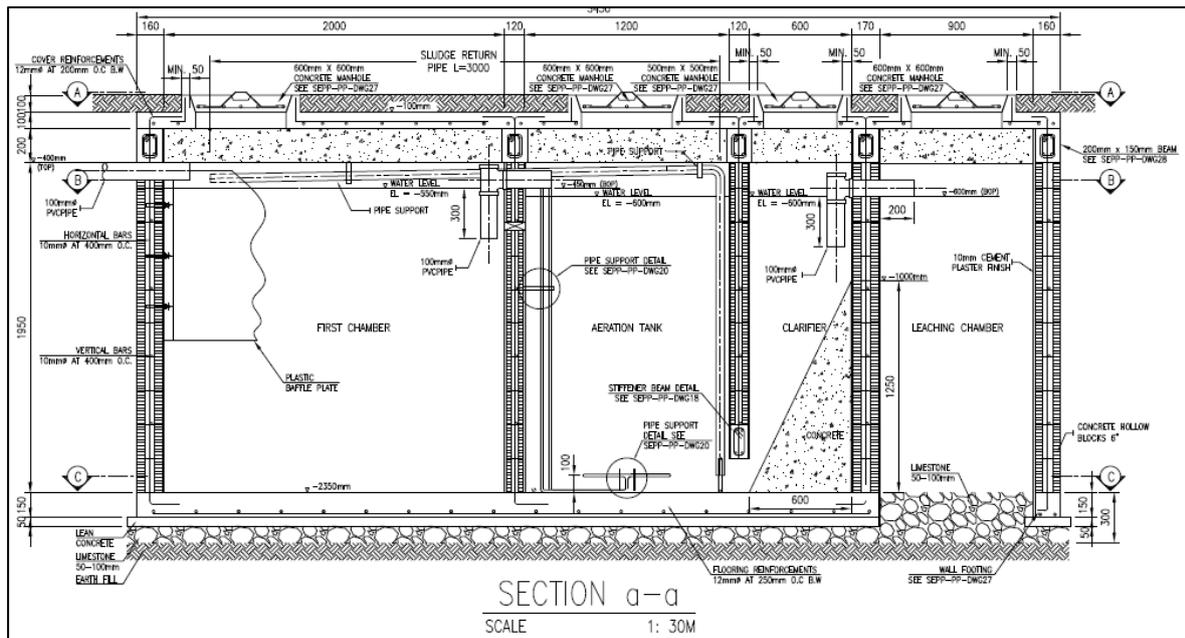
Method 3 (Site 4) エアレーション式 ST 断面図
